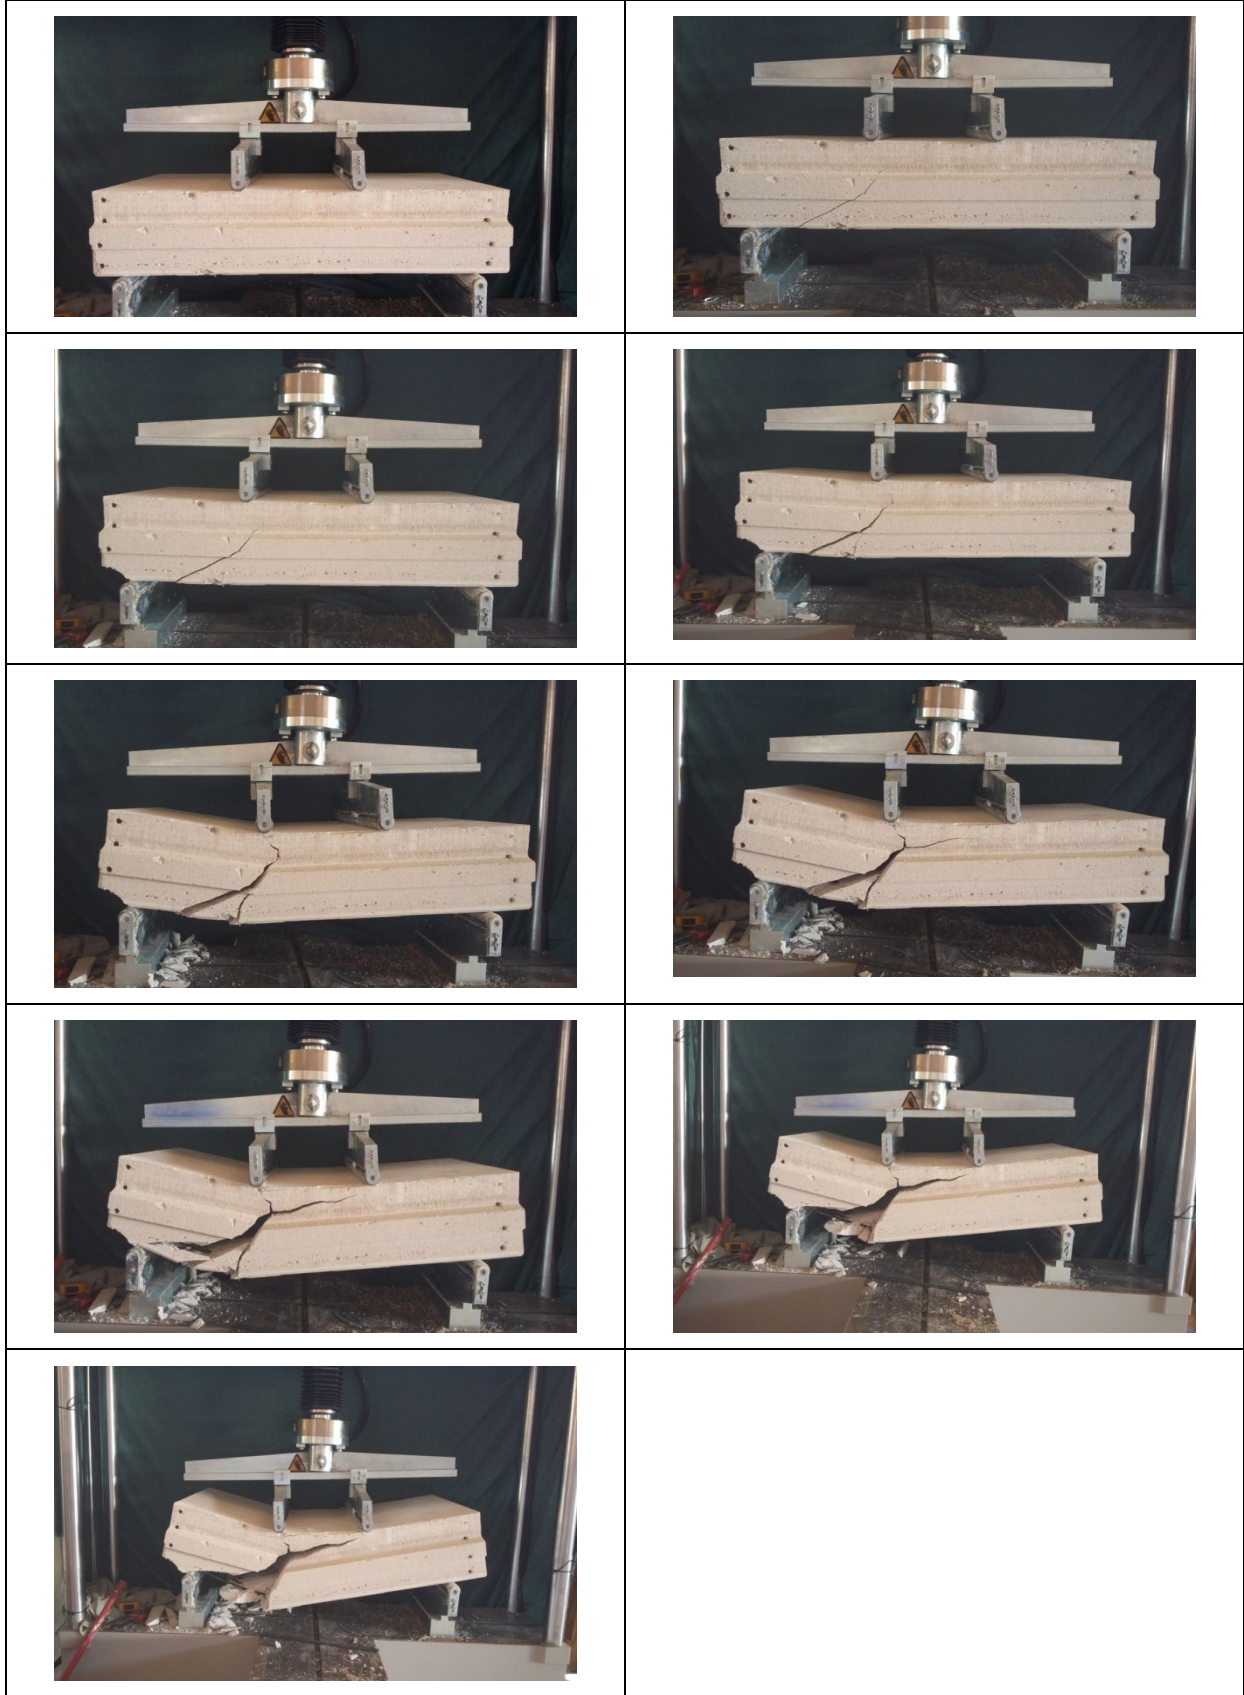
180 gün sülfat ortamında bekletilen normal betonun görünümü.
